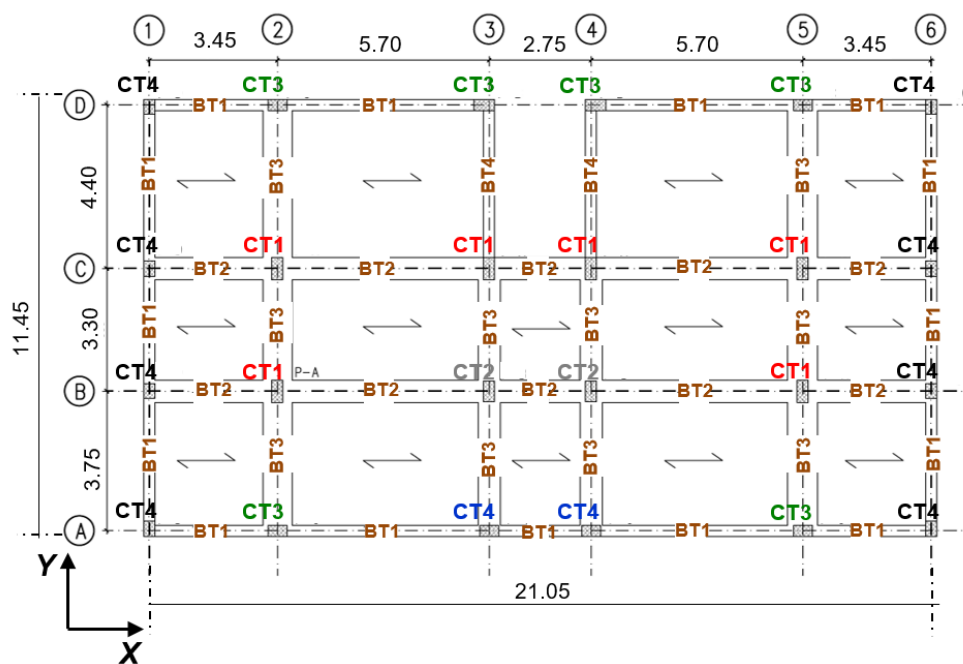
Pianta strutturale del piano terra dell'edificio (dimensioni in metri)
